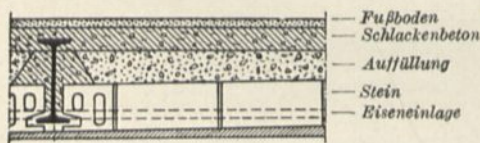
Kleinesche Decke mit ebener Untersicht. (Aus „Eisen im Hochbau“.)
